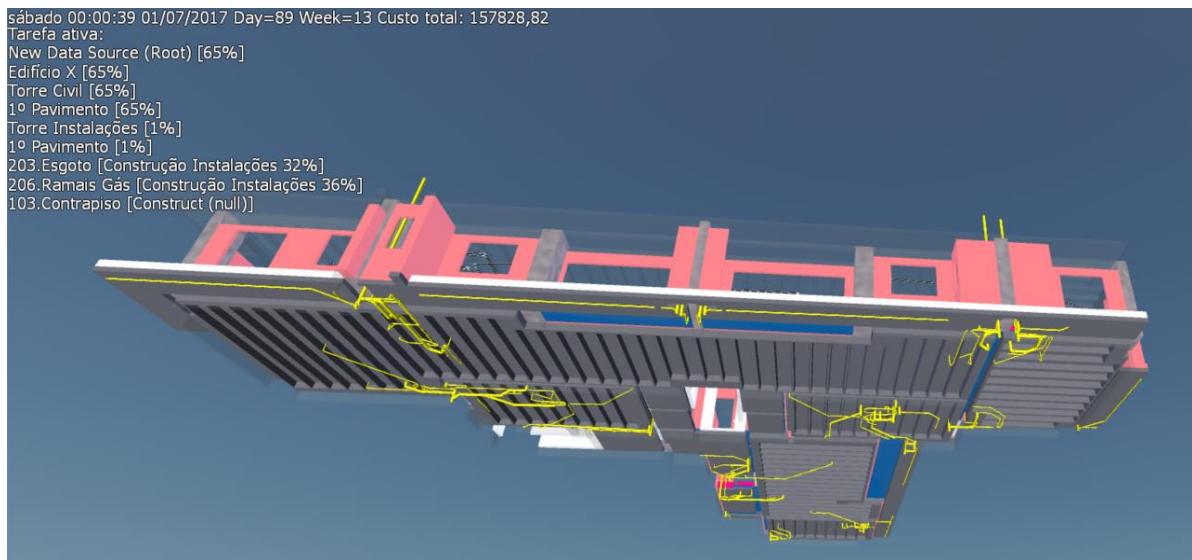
Simulação Alv. Bloco Concreto e Instalações
